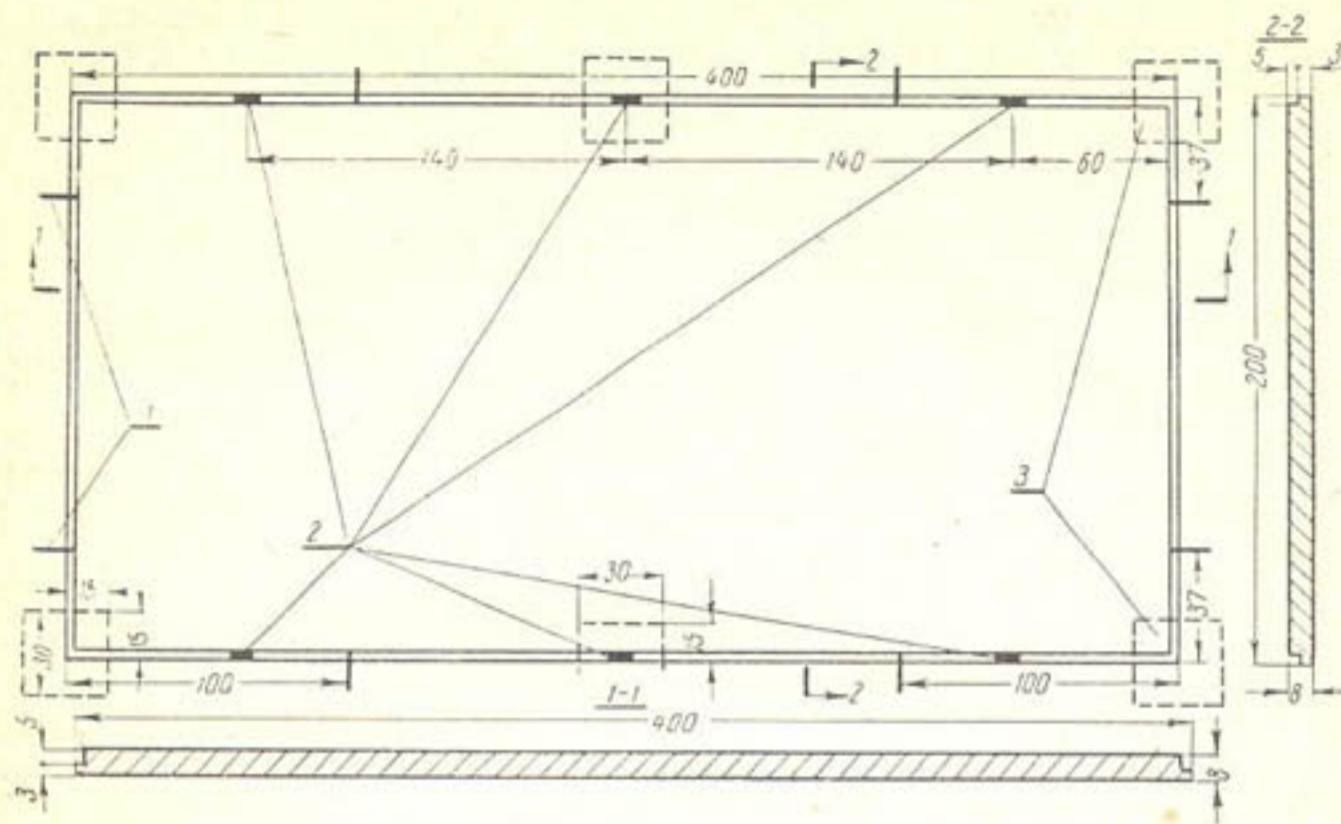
Железобетонная плита для облицовки Дальверзинского канала:
